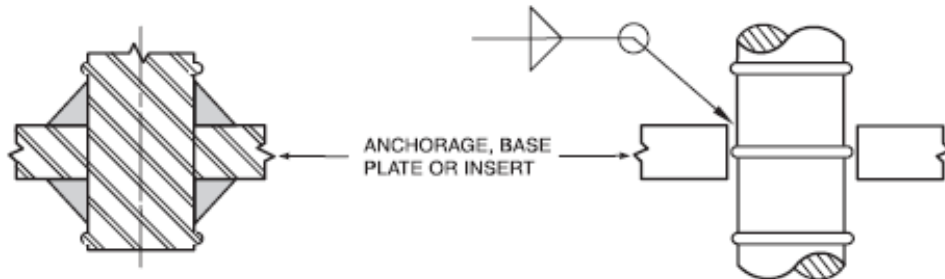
Soldadura Varillas de anclaje - Placa base
